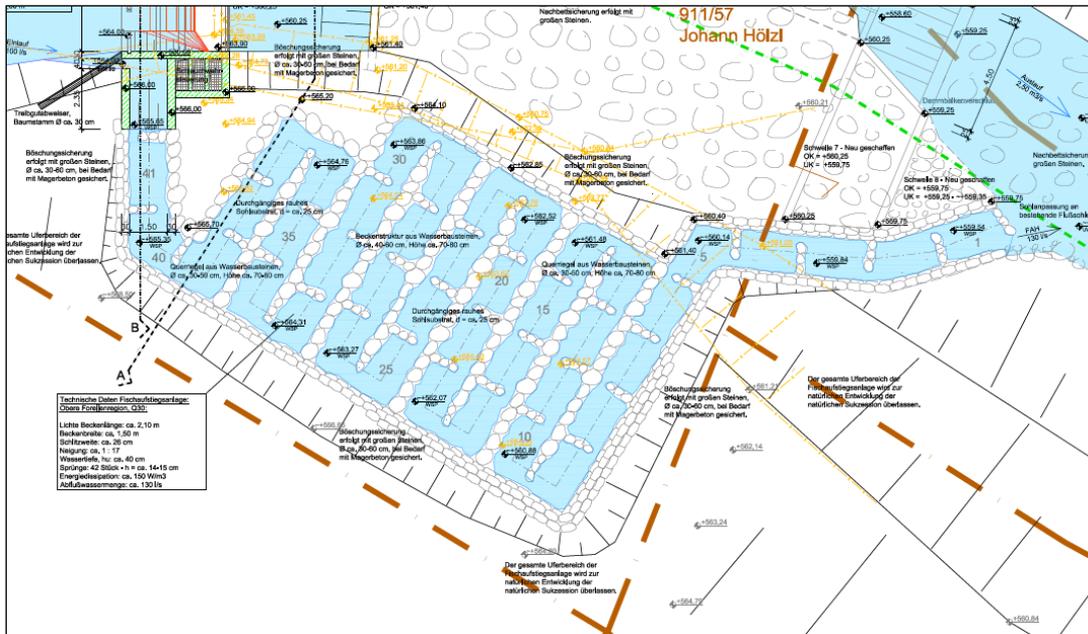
Lageplan Fischaufstieg - Planung (Auszug Planung IB Ederer 2018)
